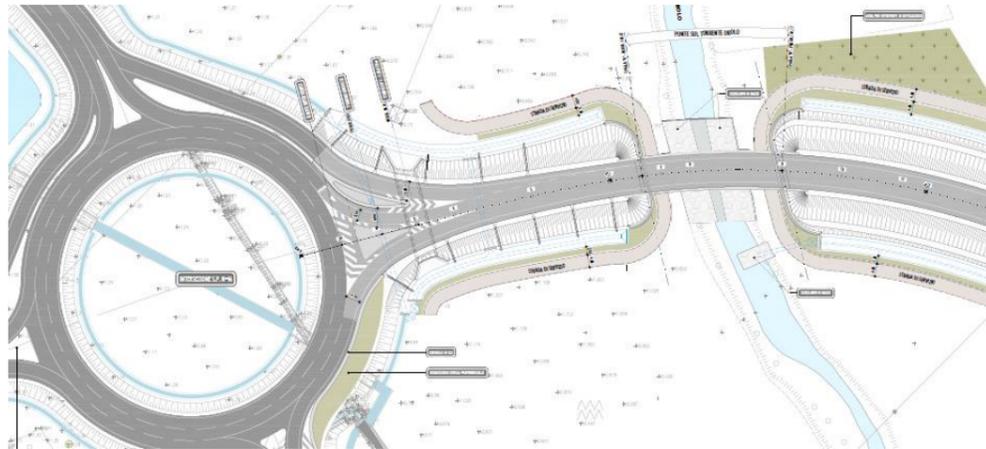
COMPLETAMENTO S.P. N° 46 – STRALCIO PLANIMETRICO
